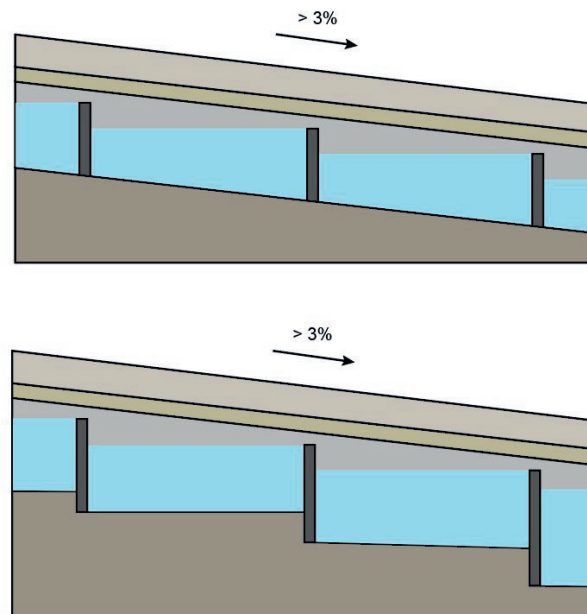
| Ejemplos de terrazas o barreras transversales en subbase de pavimento permeable (adaptado de Ayuntamiento de Madrid, 2018).
